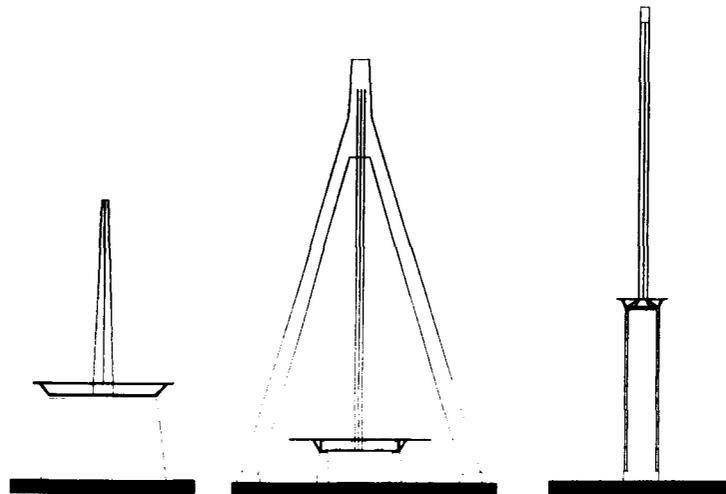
3 Formas de pilones para suspensión central (cable en un solo plano)
